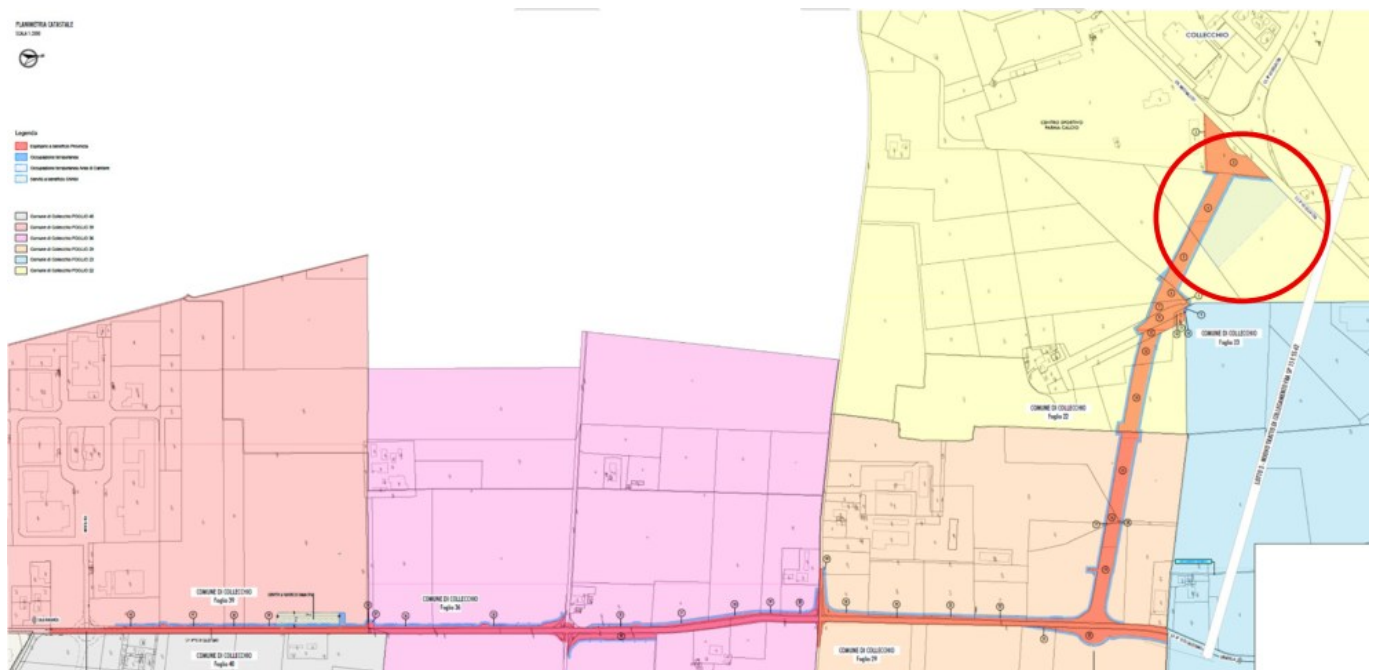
Area di cantiere Lotti 2 e 3.
